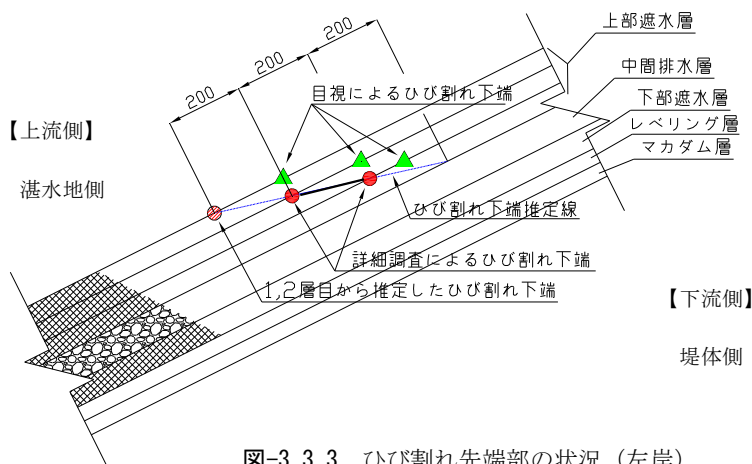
ひび割れ先端部の状況(左岸)
